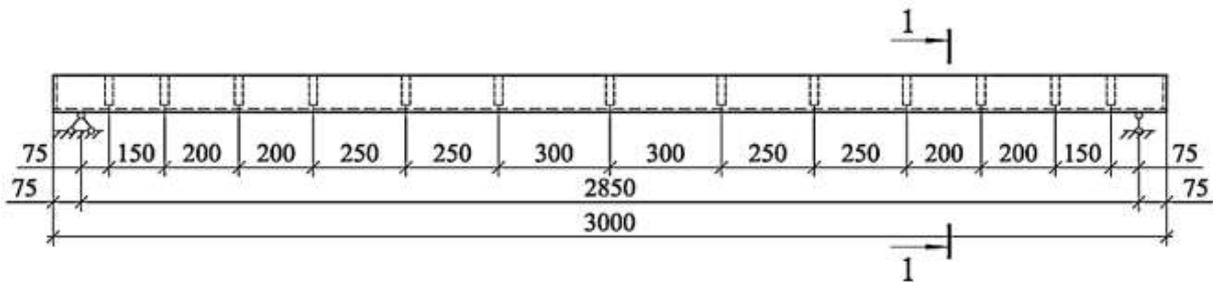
Схема розміщення анкерів до внутрішніх стінок стінок балки
